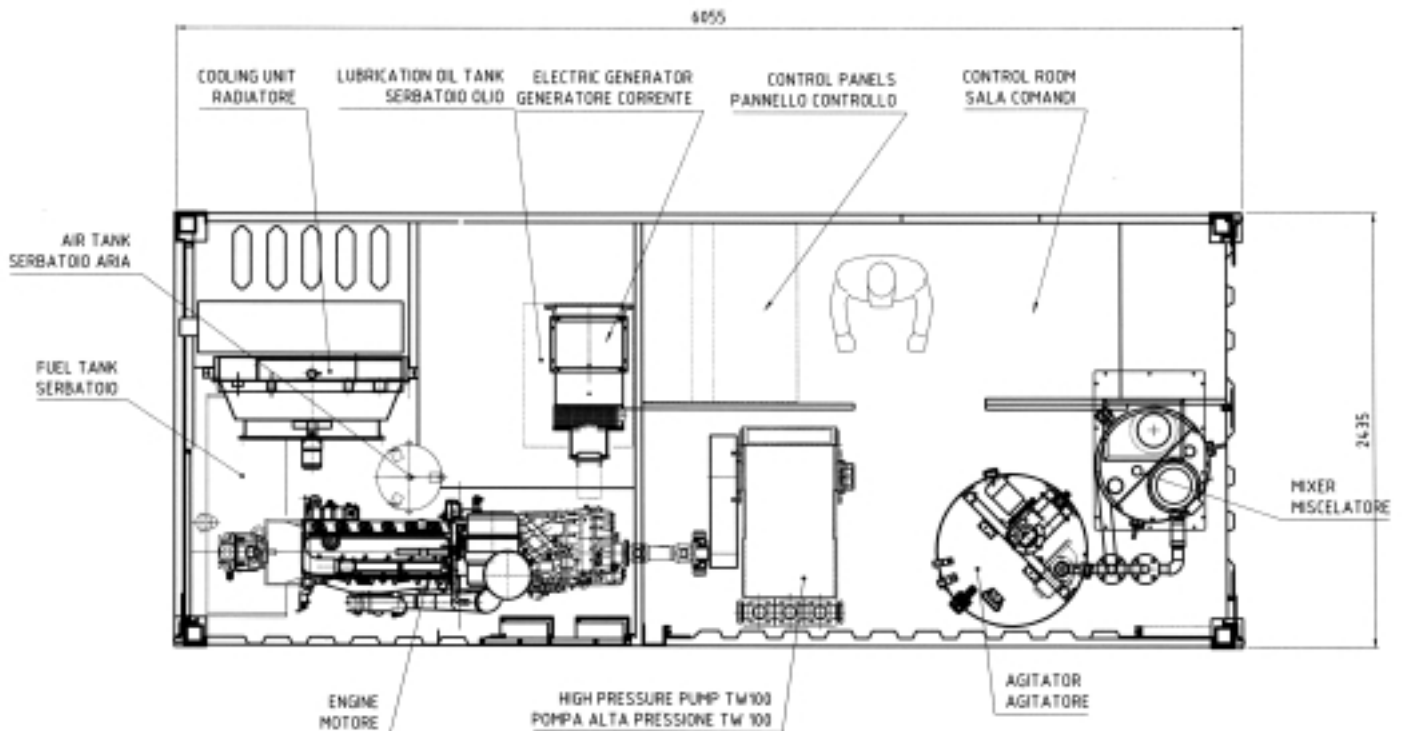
Unità "MINIJET" (schema planimetrico) / "MINIJET" unit (planimetric scheme).
